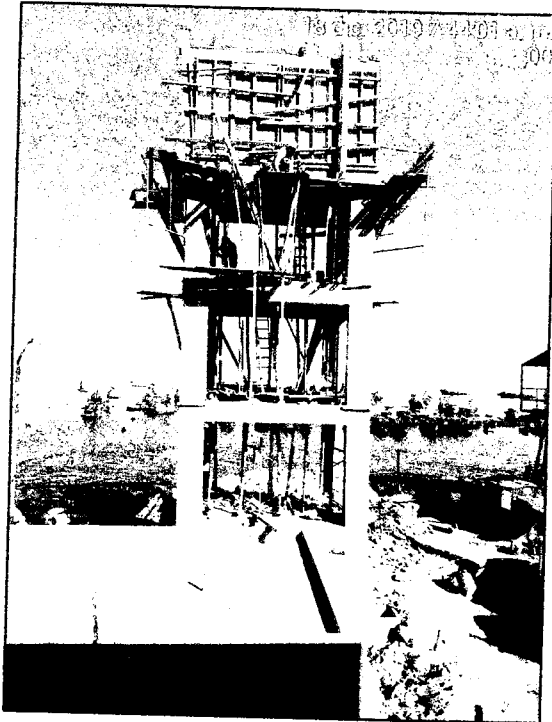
y 14: Vista de los Trabajos realizados en area de Tanque elevado, tarrajeo exterior de tanque elevado.
